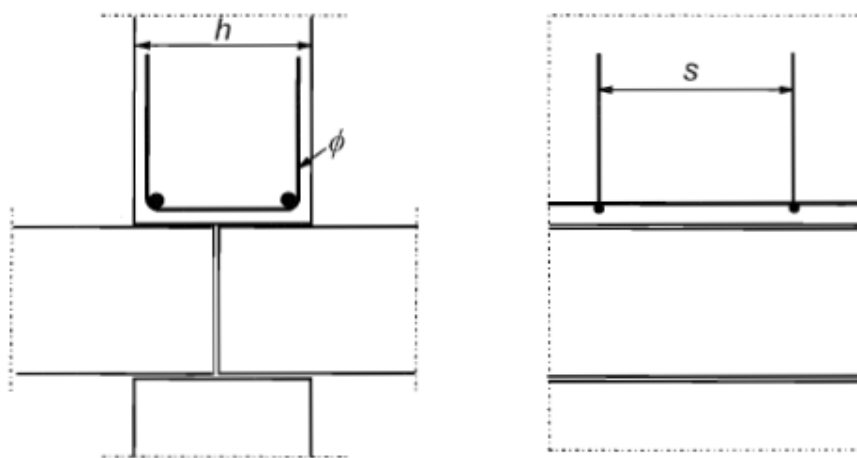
Ejemplo del refuerzo de muro sobre la conexión entre dos losas de piso. Adaptado de: Eurocode 2: Design of Concrete Structures. (2004).
